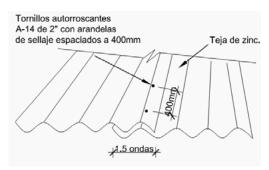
Detalle de la fijación de las tejas o láminas de zinc de la cubierta.
